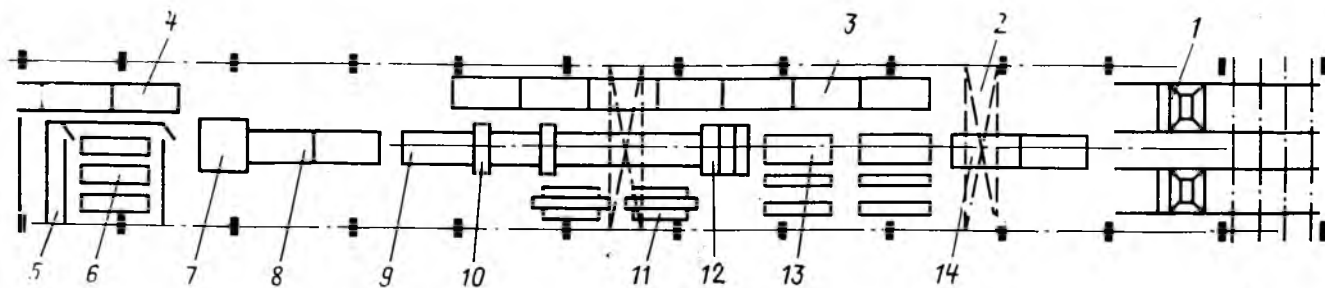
Схема полуконвейерной технологической линии для изготовления плит пакетным способом
